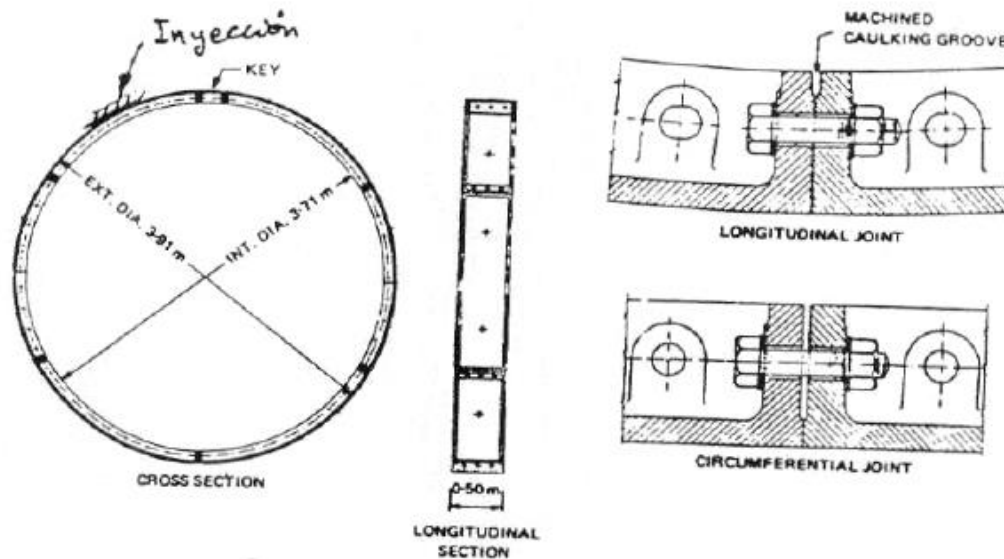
Impermeabilización en túneles contruidos mediante dovelas prefabricadas(Sánchez, 2003)
